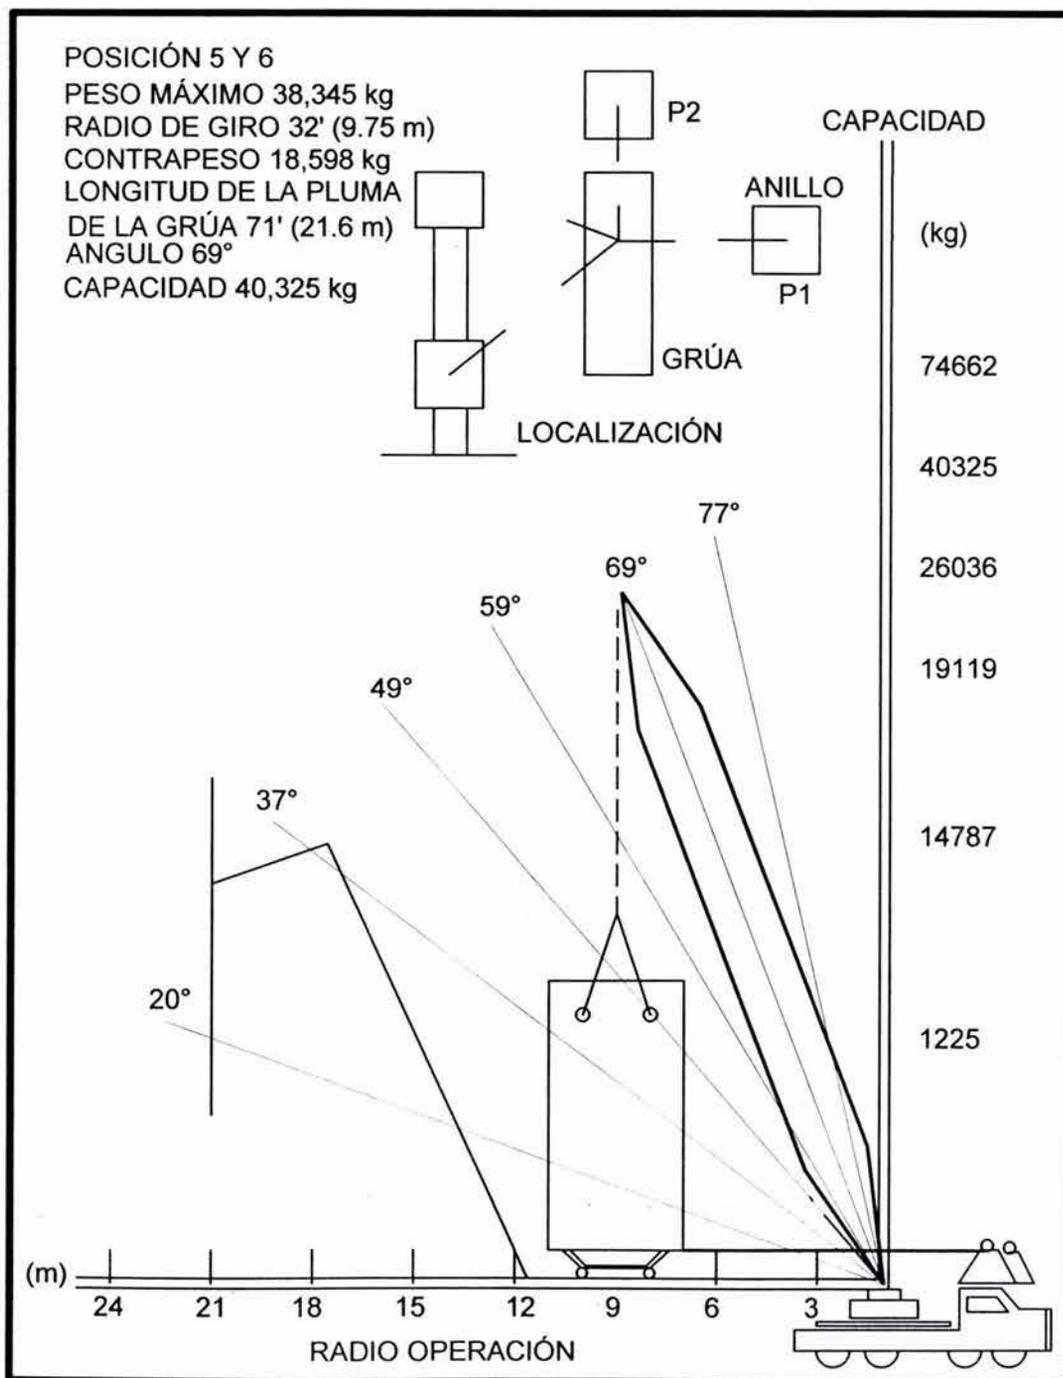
TERCERA ETAPA: TRASLADO DEL ANILLO METÁLICO
